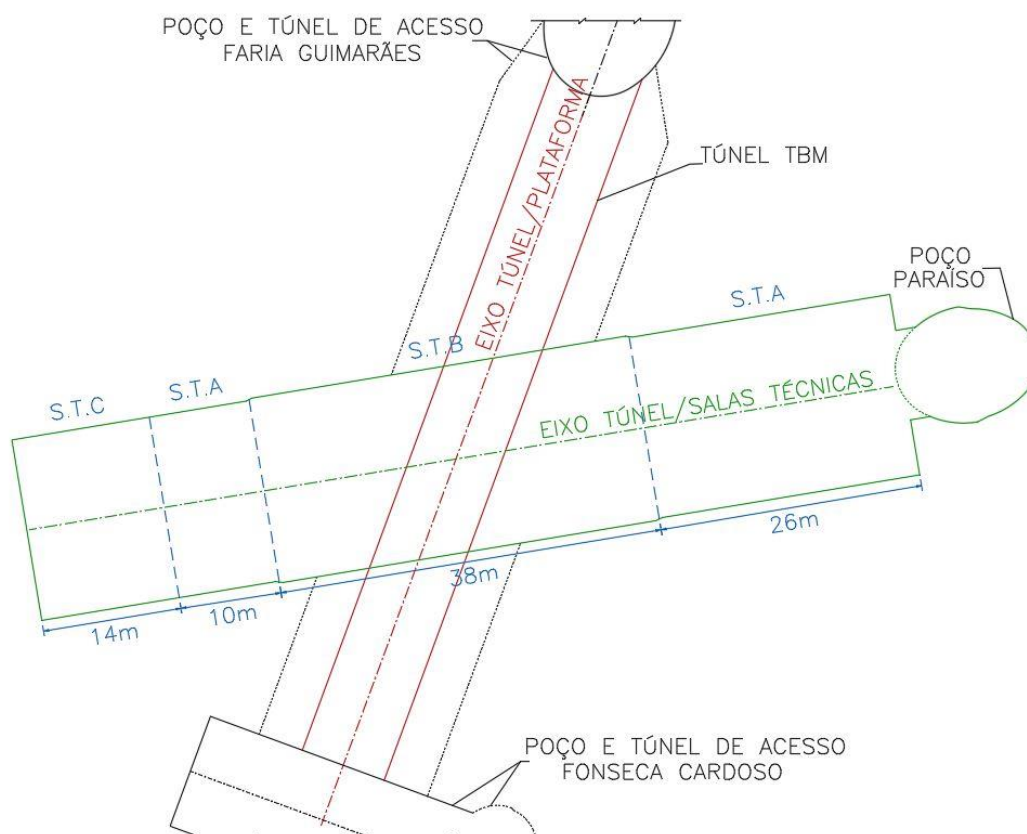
Representação em planta da estação Faria Guimarães.¹
